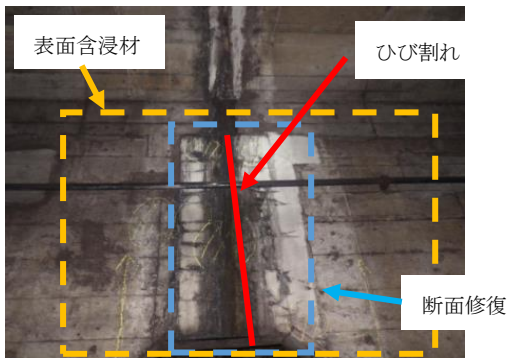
断面修復箇所の顕著なひび割れ (B線 13k583m)
